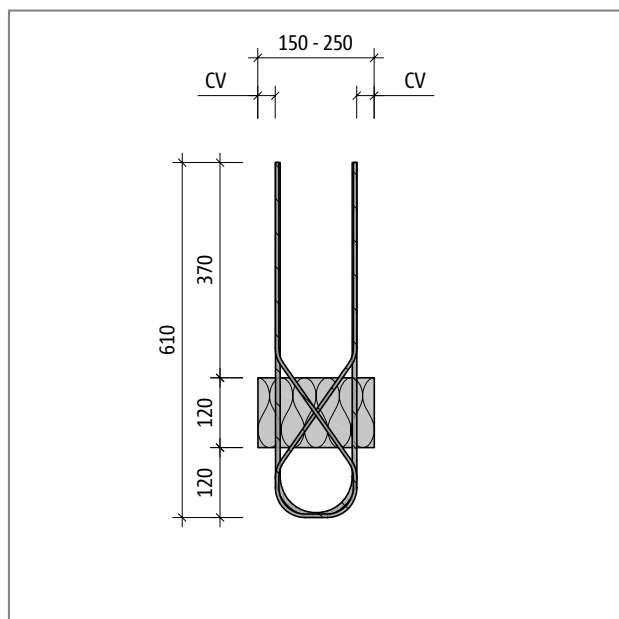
Schöck Isokorb® tipo ABXT, sezione trasversale del prodotto
